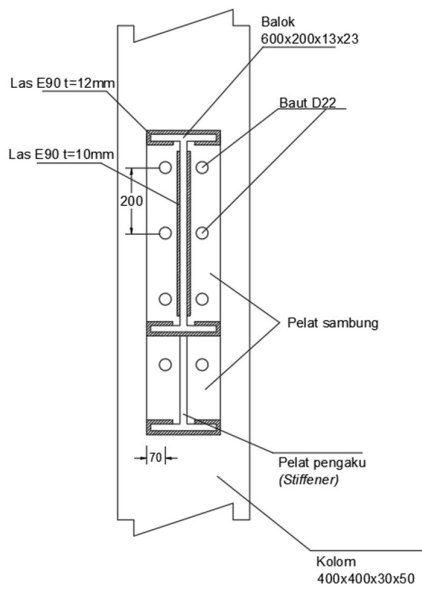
Denah Perletakan Sambungan Balok-Kolom
